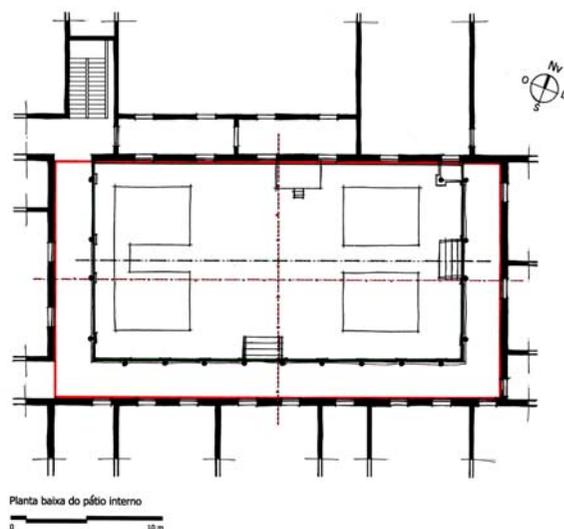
Estudo da configuração espacial do pátio interno principal do CII, planta baixa. (Princípios de ordem: eixo e simetria) (Fonte: O AUTOR,2006).
